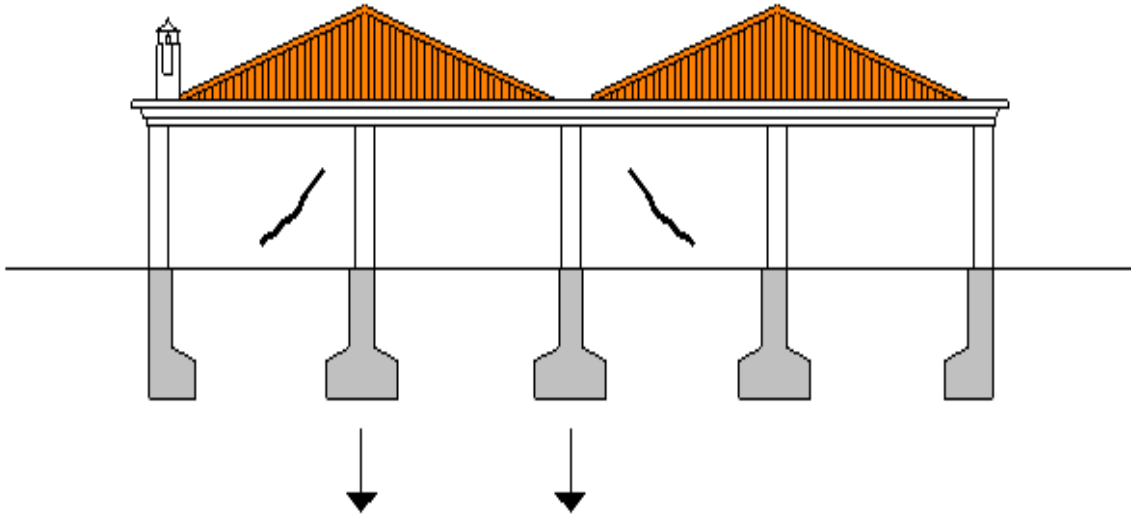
Família de fissuras originadas pelo assentamento de parte da estrutura (Modificado, Ortiz, 1983).
